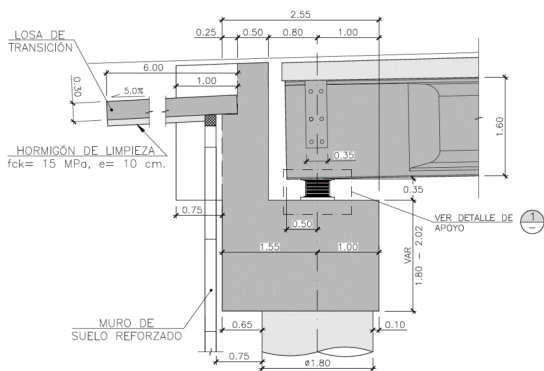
Detalle apoyo estribo E-11 con aislamiento sísmico.
